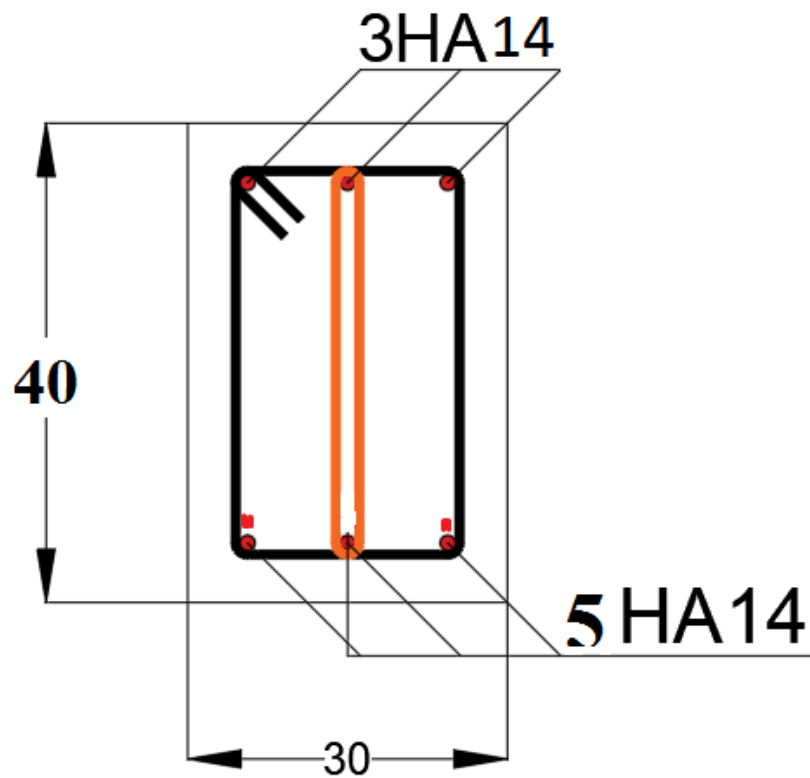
Schéma de ferrailage de la poutre principale (Travée)
